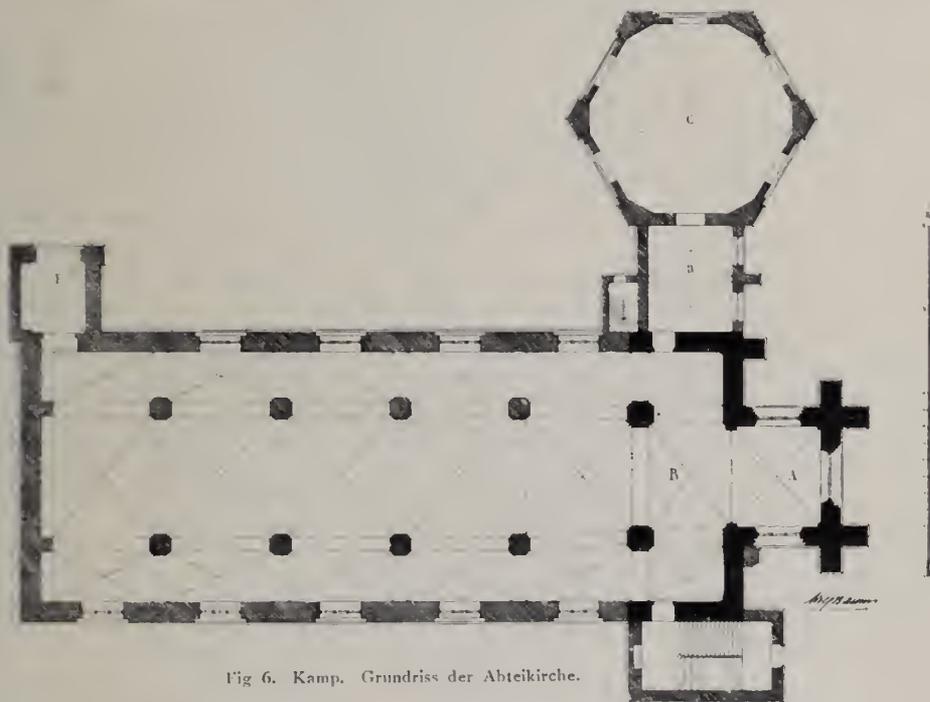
Kamp. Grundriss der Abteikirche.
